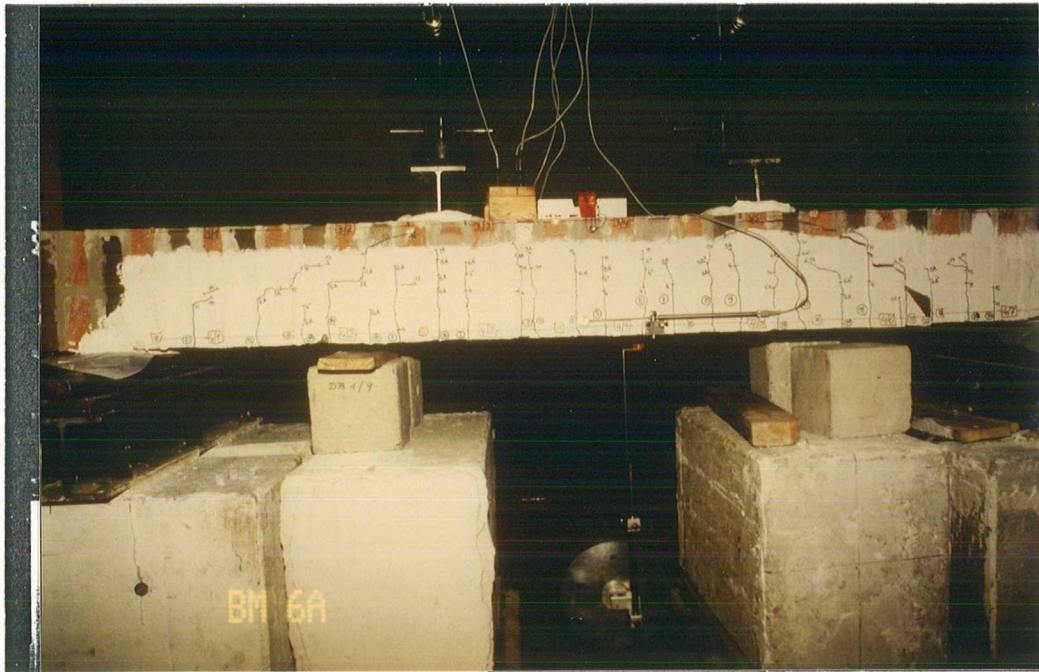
Versuch I/6a nach dem Versagen durch Schubbruch
